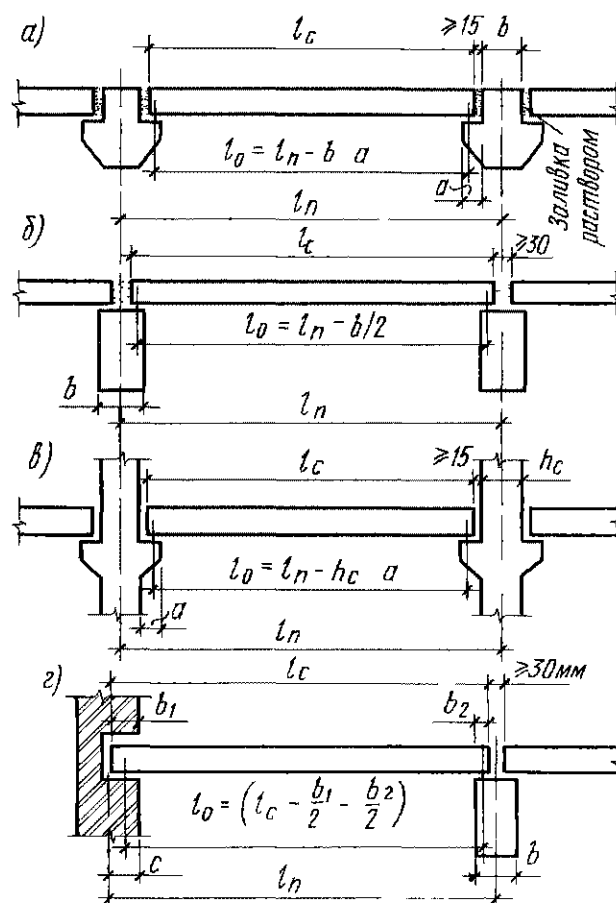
Расчетные пролеты плит при опирании: а — на полки ригелей, б — по верху ригелей, в — на капитальную колонну (консоль), г — на стену и прогон
